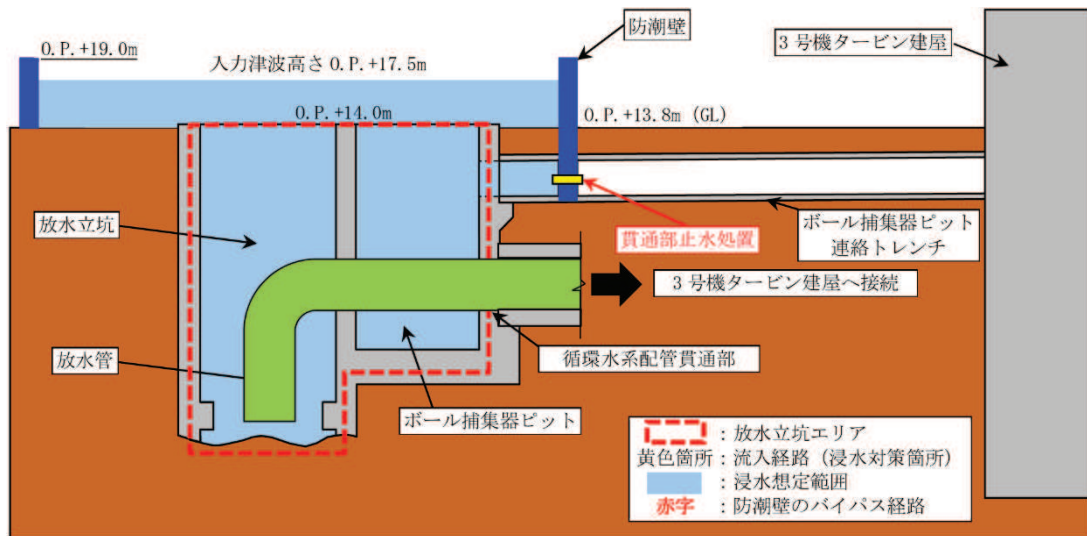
第 3 号機 放水立坑 流入対策配置図 (A-A 断面図)
